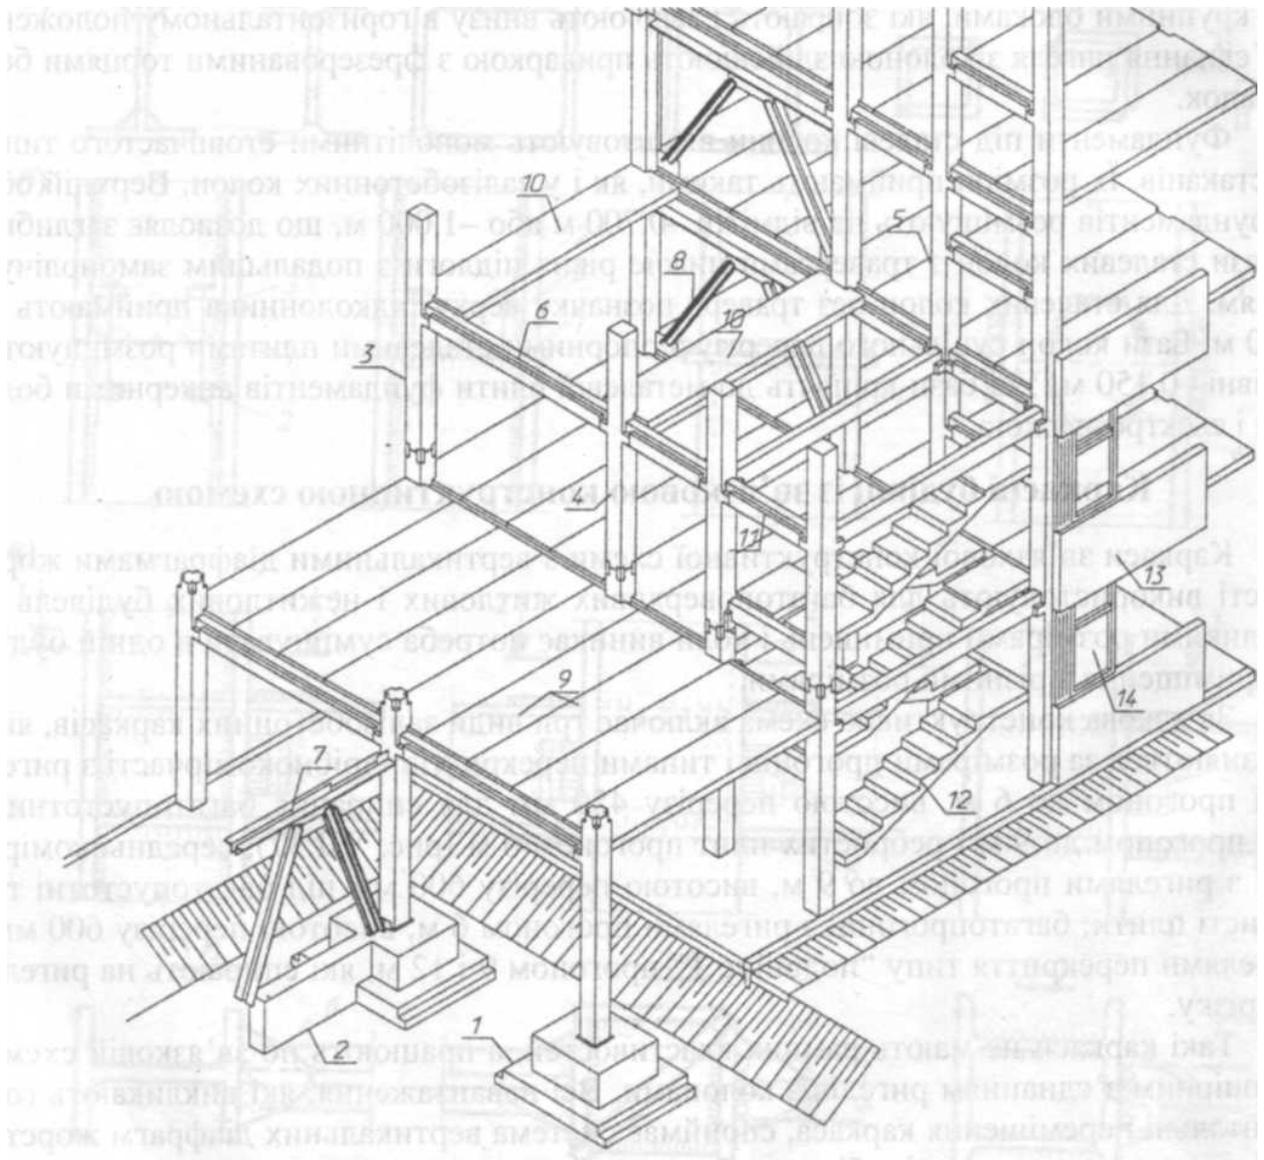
Основні елементи багатоповерхової промислової будівлі із зв'язковим залізобетонним каркасом:
